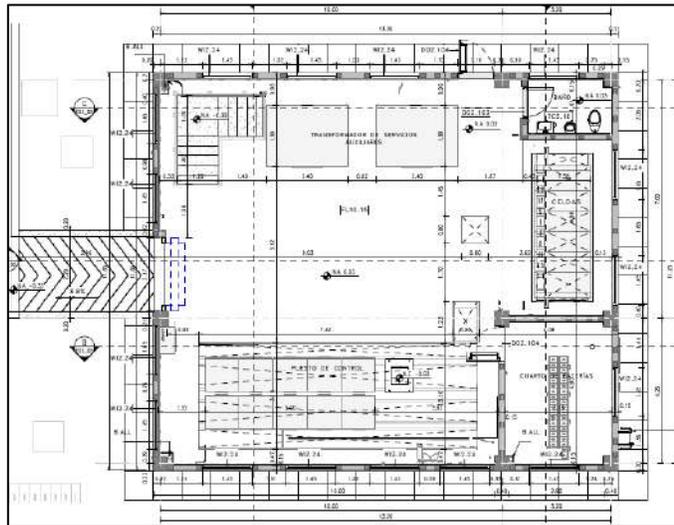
Planta general Caseta de control SER 1.
